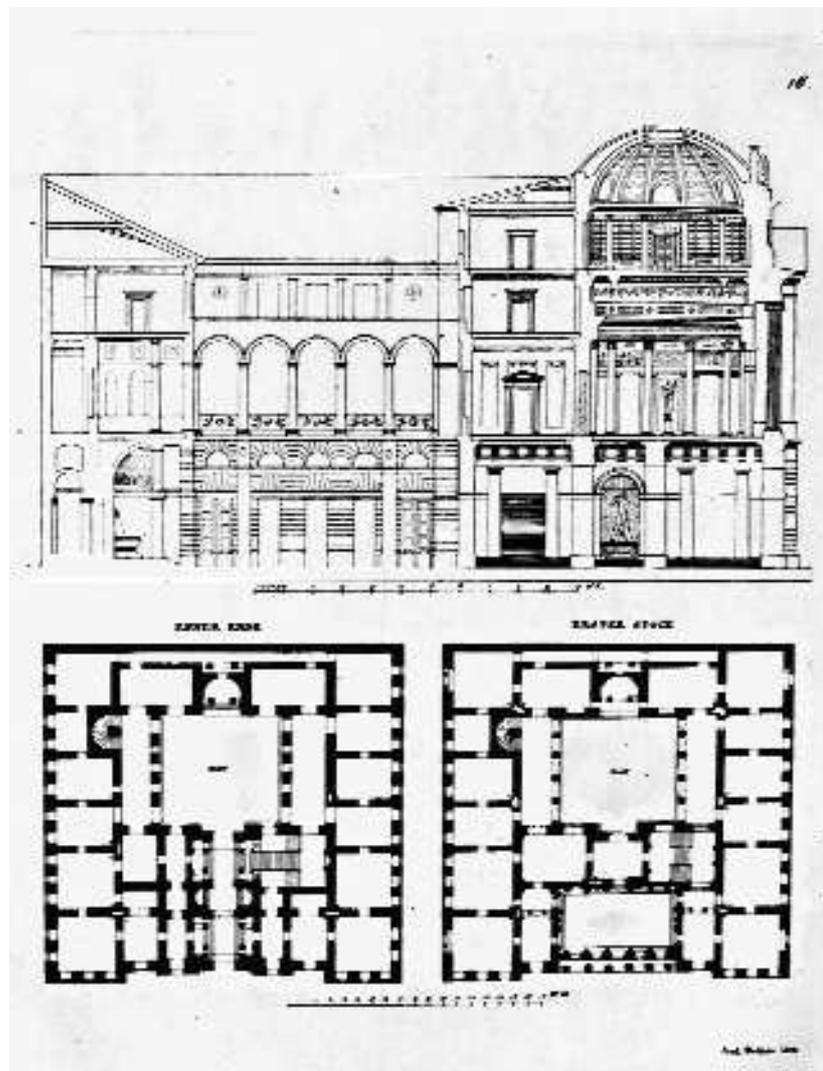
Ortner, Bürgerliches Wohnhaus mit Bibliothek, Querschnitt und Grundrisse, 1825
